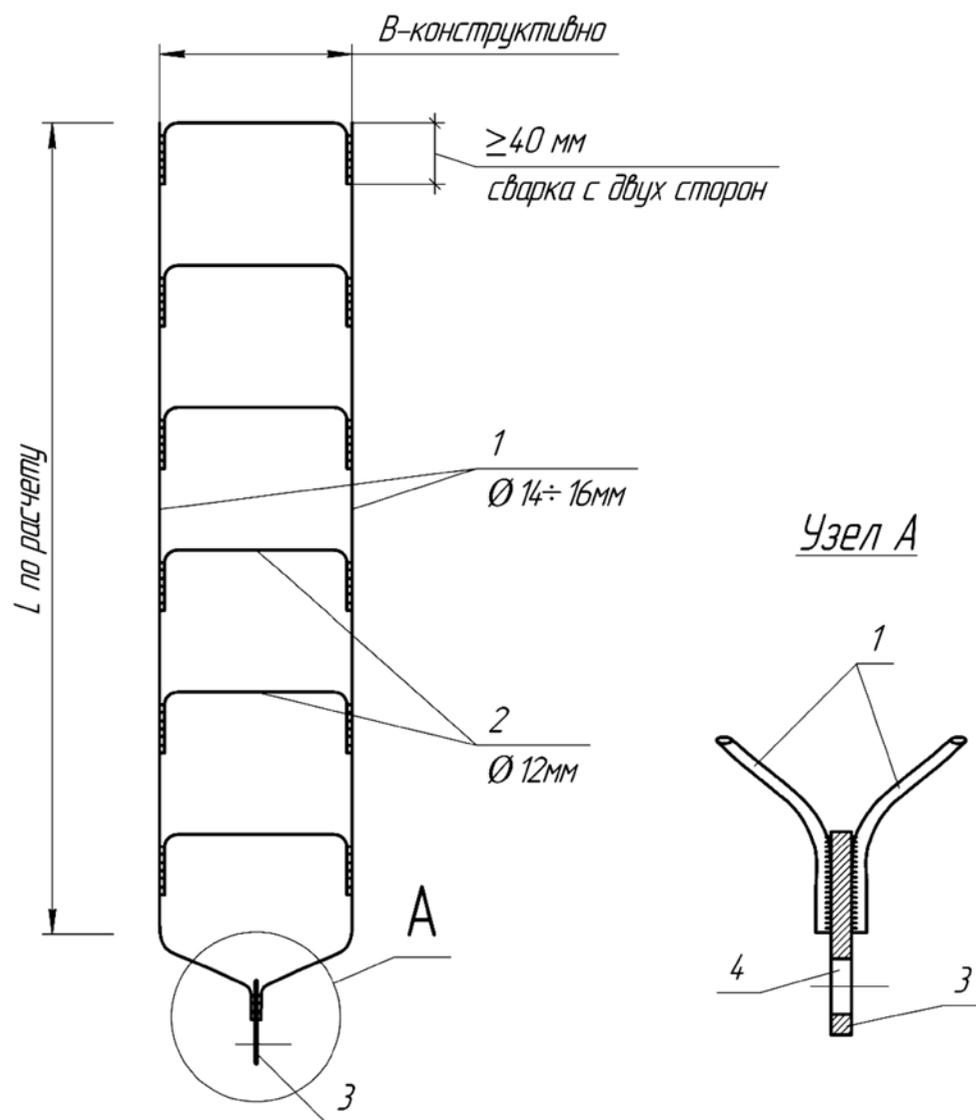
Анкерующий элемент в виде арматурного каркаса.
